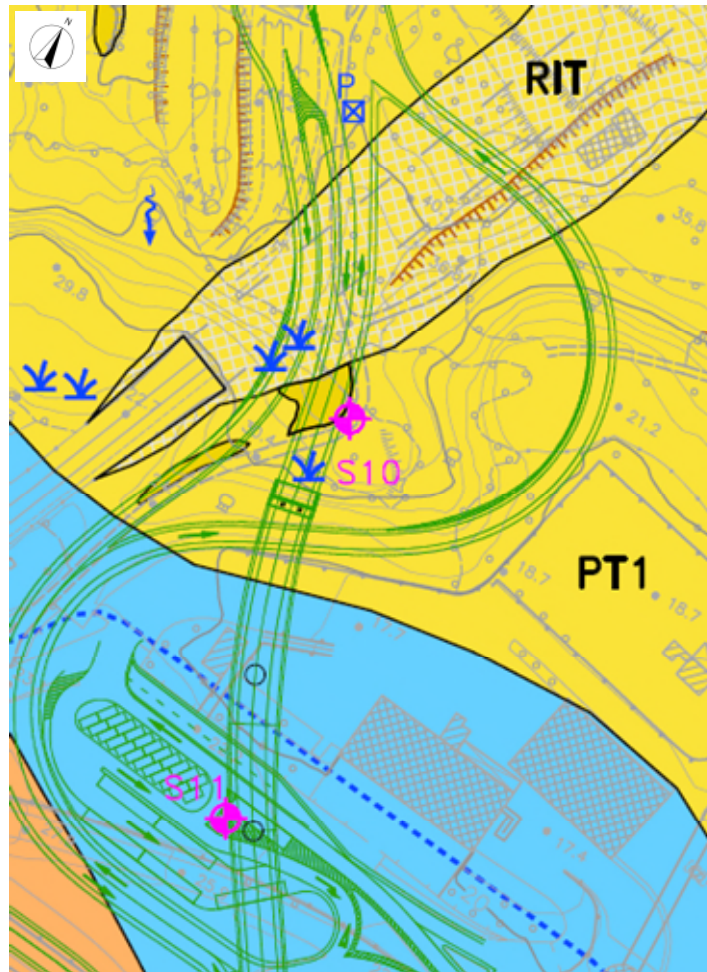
Planimetria ramo Vado Ligure – Casello
